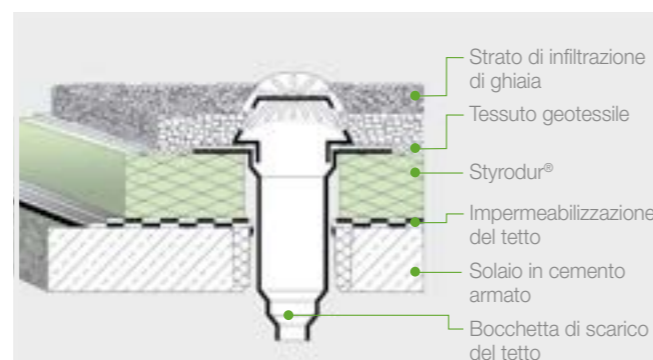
Bocchetta di scarico con due piani di drenaggio dell'acqua per il drenaggio della superficie del tetto sopra e sotto allo strato isolante.
